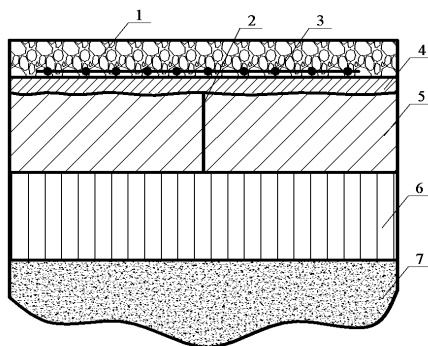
Усиление цементобетонного покрытия асфальтобетоном с использованием геосинтетических материалов с устройством выравнивающего слоя:
